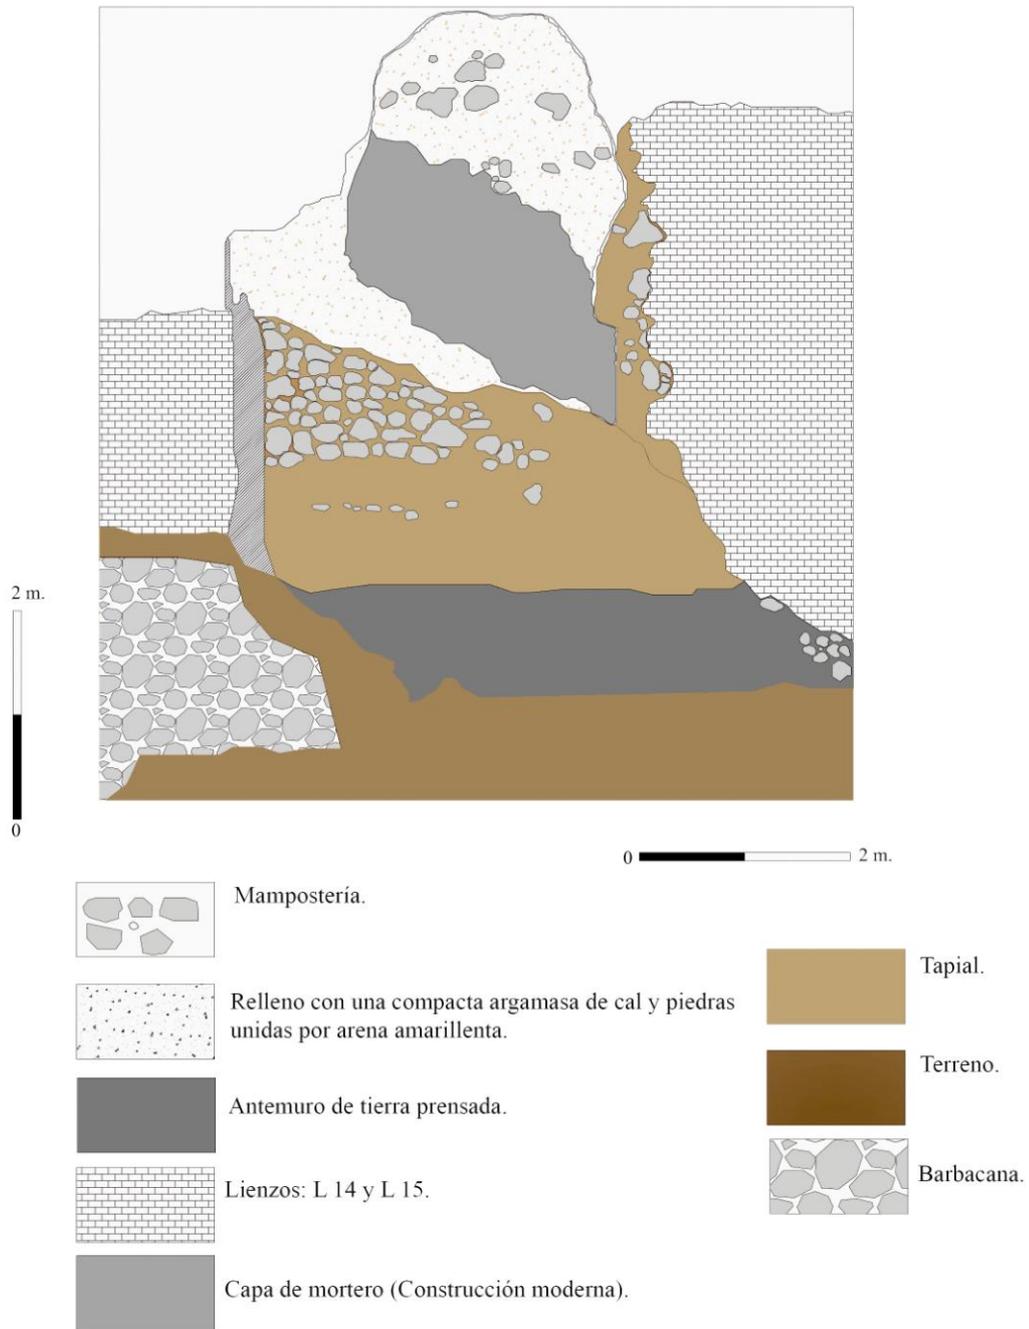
La torre (T_14) en su cara oeste. La técnica constructiva, tapial y mampostería. (Elaboración propia).
